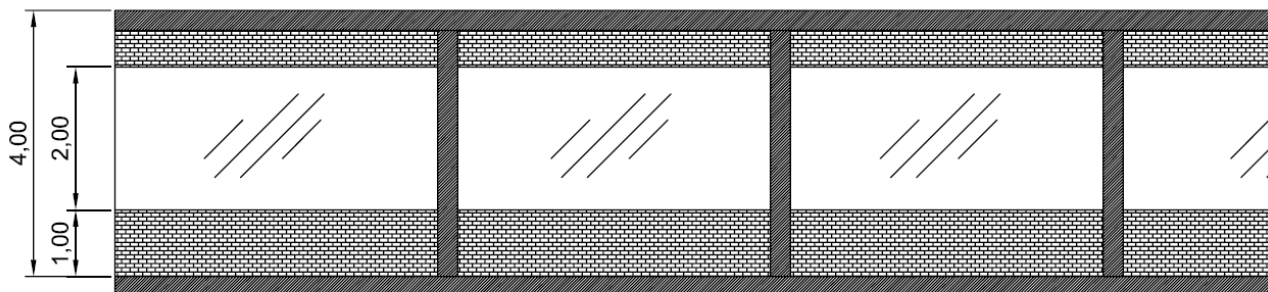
Propuesta de colocación de huecos sobre fachada norte y sur
